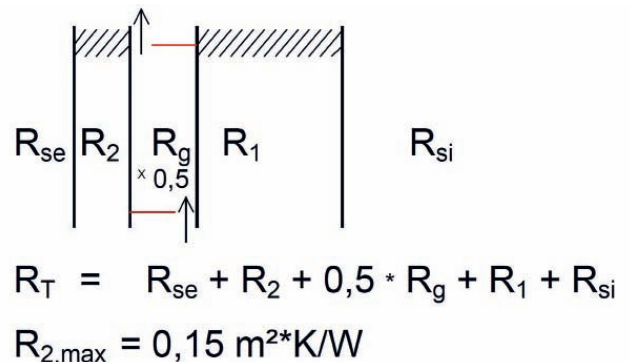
Слабо вентилируемая воздушная прослойка (незначительно вентилируемая прослойка)
